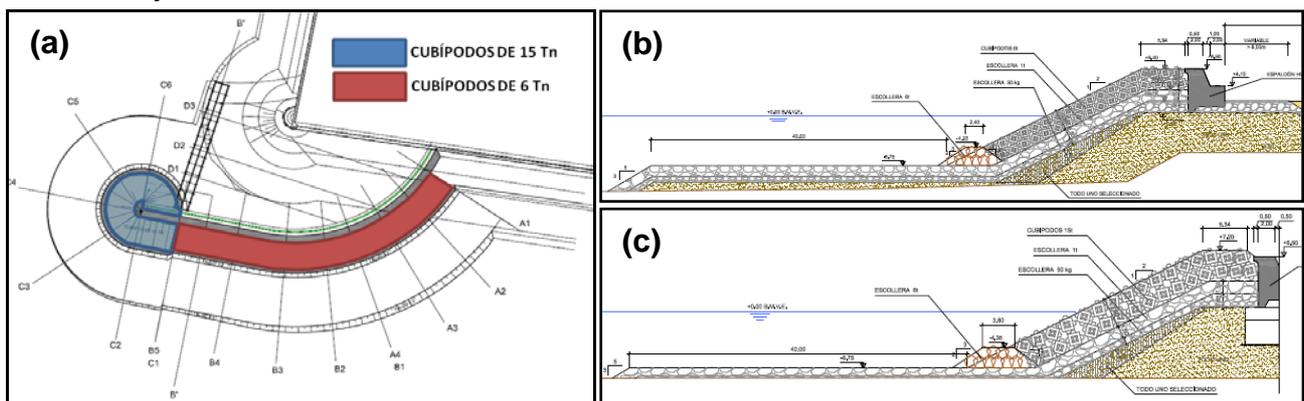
(a) Planta y secciones tipo del (b) tronco y (c) morro del Dique de San Andrés
